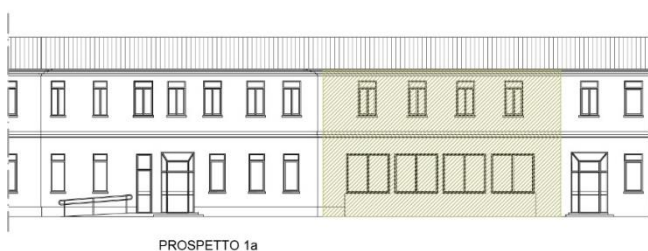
Individuazione del macroelemento in prospetto e pianta
